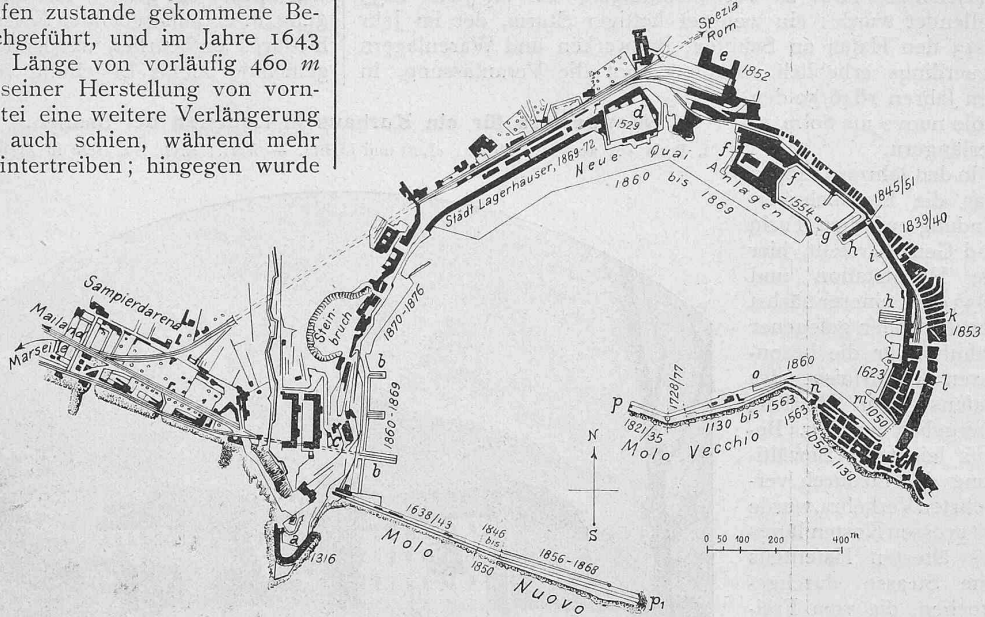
Lageplan des Hafens im Jahre 1876. — Masstab 1 : 20 000.
